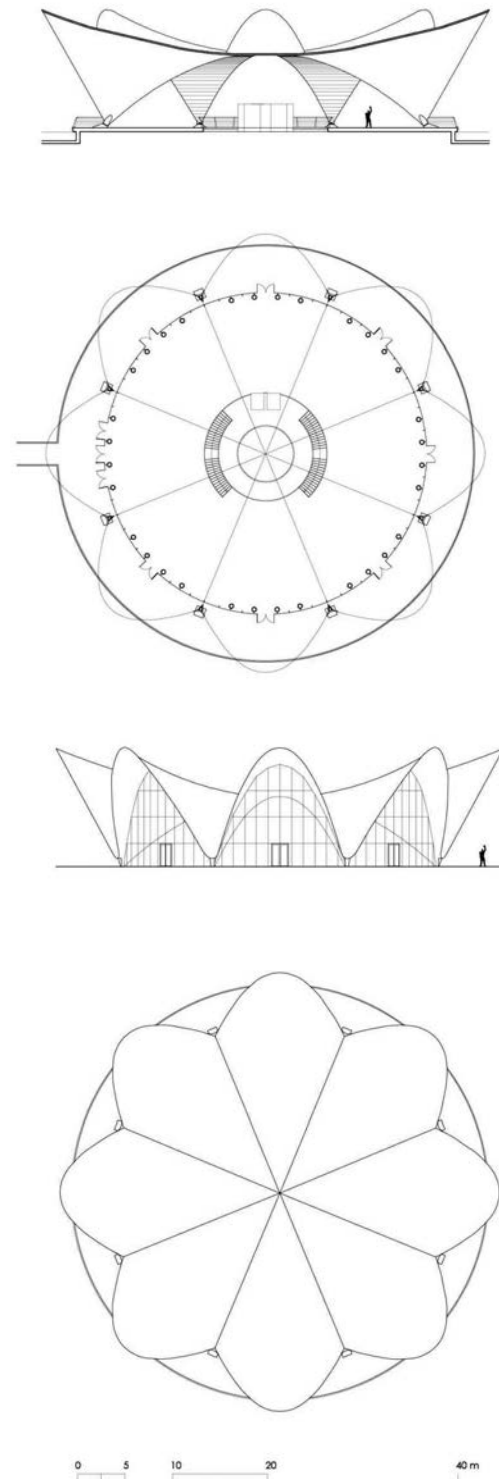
Planos de la cubierta del edificio de acceso al “Parc Oceanogràfic”.
